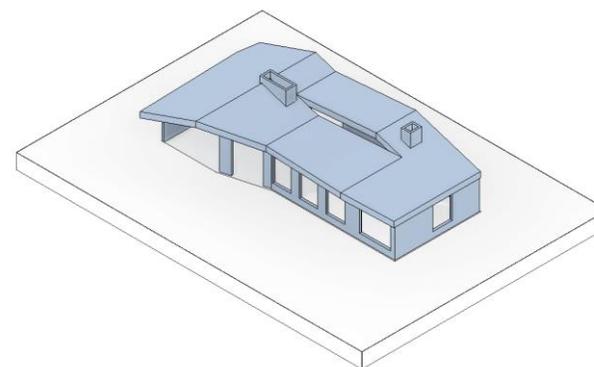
Modelo en Revit, fase muros y cubierta: Elaboración propia.
